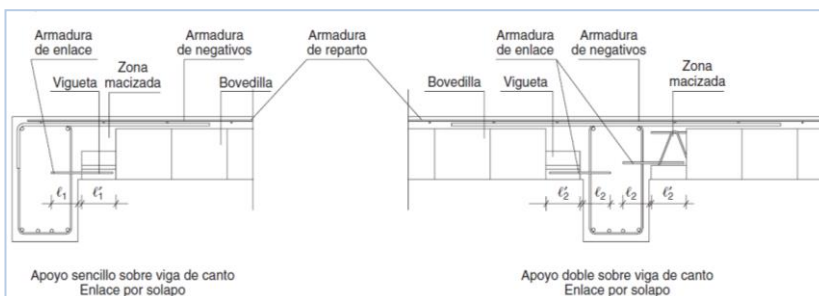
y 18. Apoyo sobre viga de canto. Enlace por solapo
